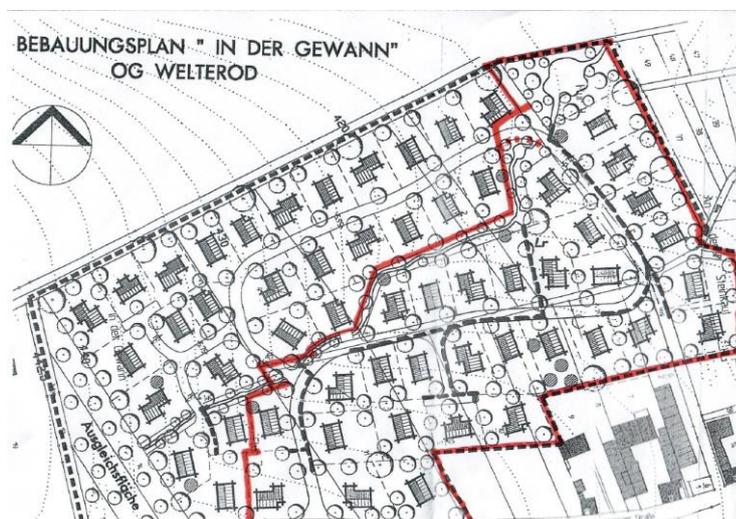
Städtebauliches Konzept Bebauungsplan „In der Gewinn“
